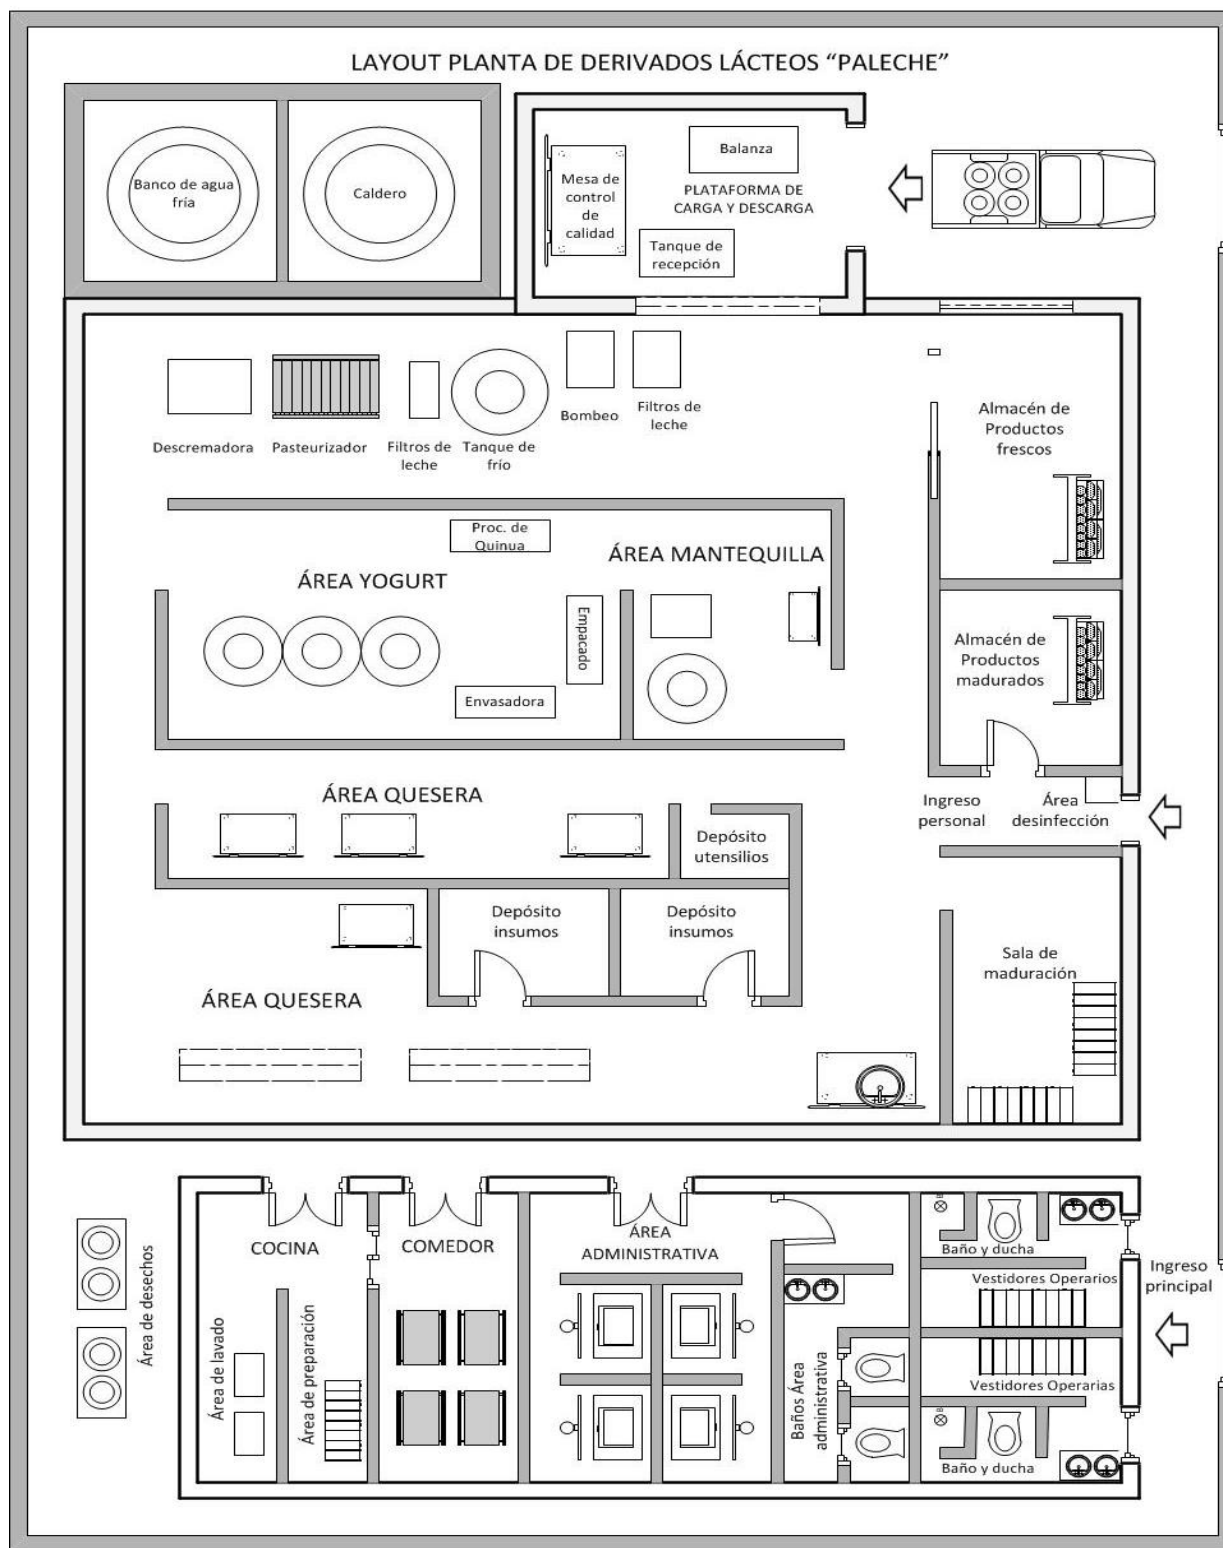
Layout de la Planta de derivados lácteos de Papel Pampa
